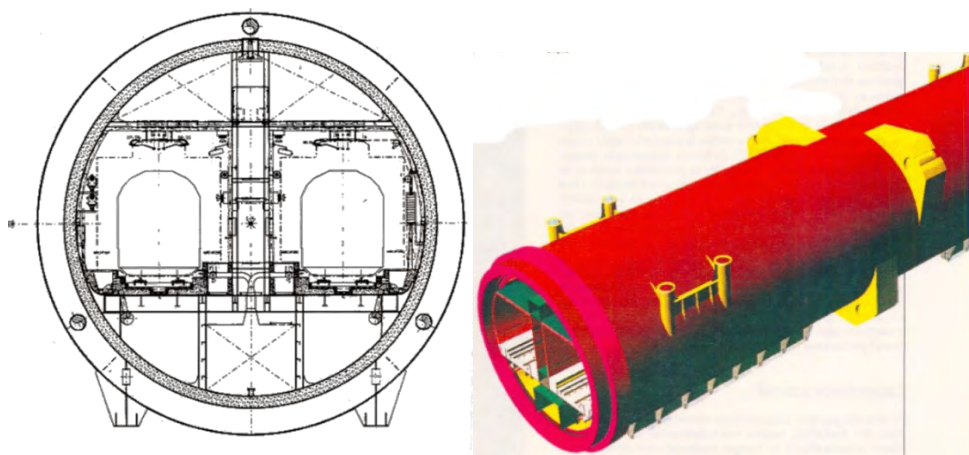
Tunnel sommerso progetto ENI 1993 – Sezione tunnel ferroviario
